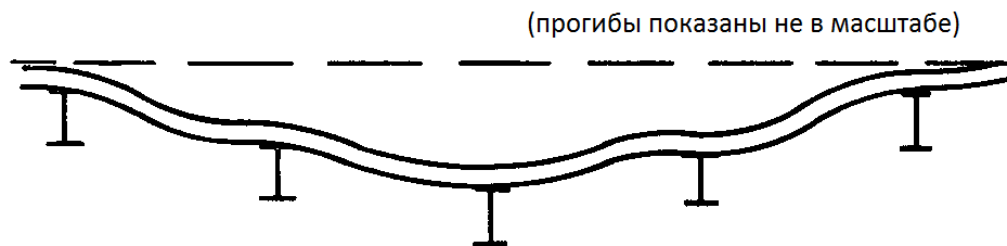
Сечение перекрытия, демонстрирующее типичную основную форму колебаний
